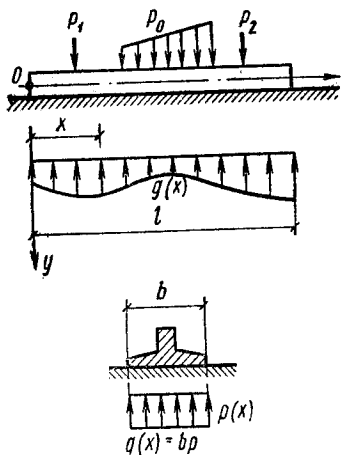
К расчету балки на упругом основании с коэффициентом постели
